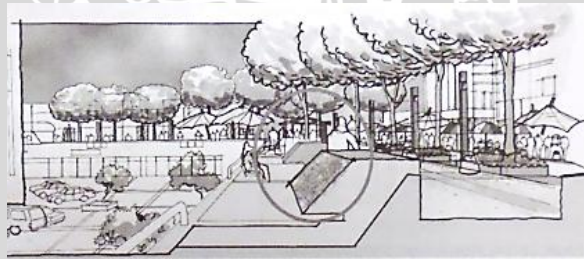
Elemen pembentuk lantai pada ruang luar
